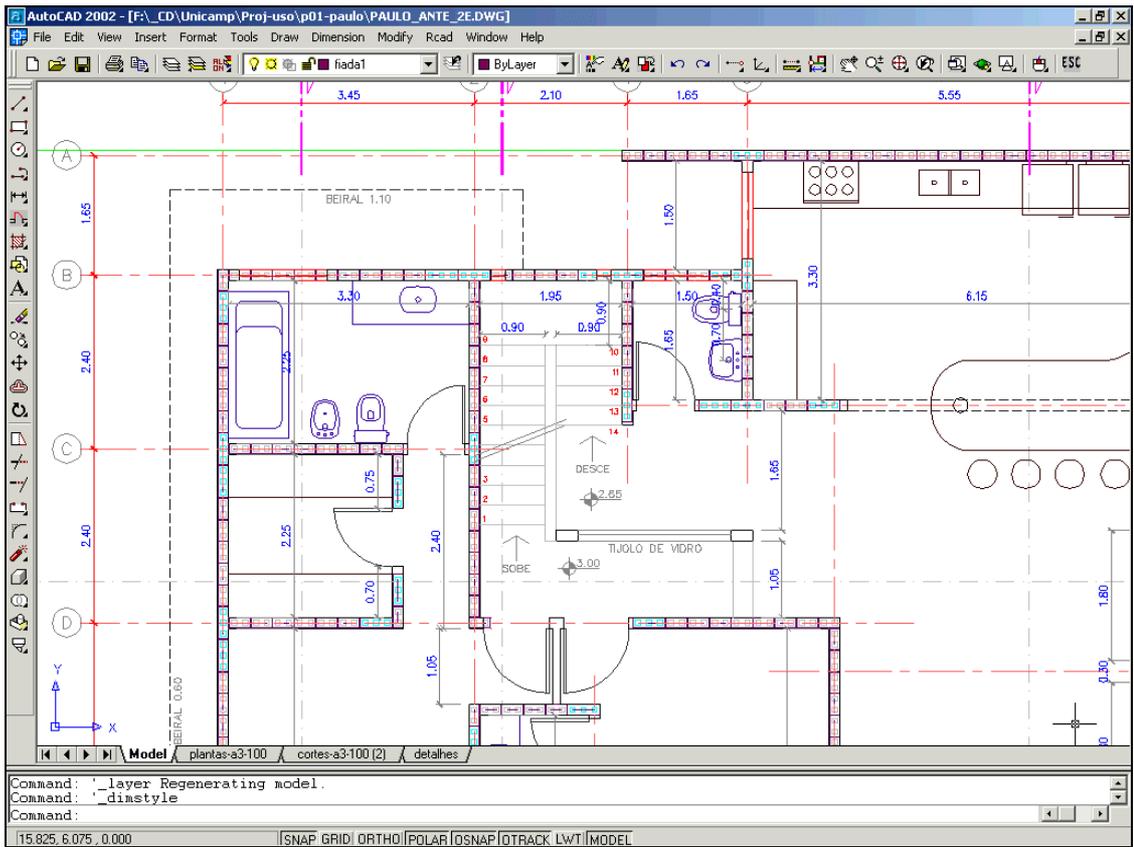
Detalhe do arquivo do anteprojeto ajustado para a modulação em alvenaria estrutural – Projeto 2 - Panizza
